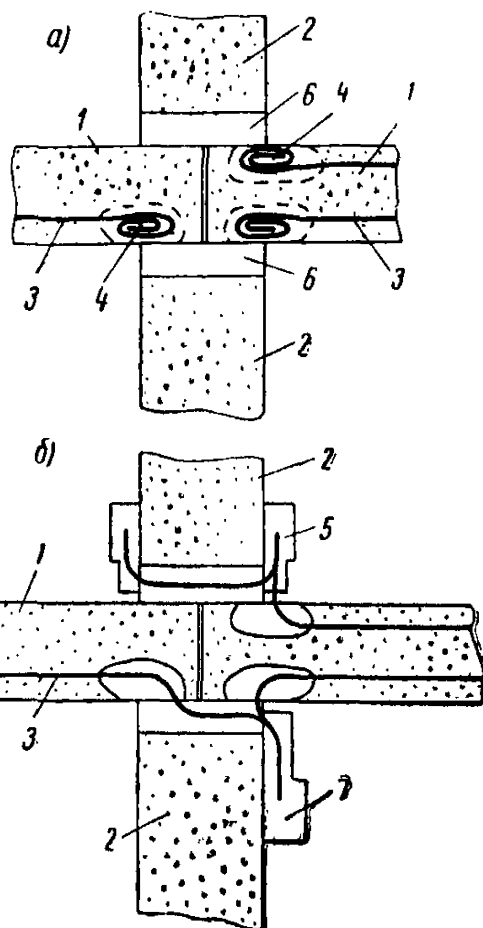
Соединение проводов смежных панелей при замоноличивании электропроводок только в панели перекрытий
